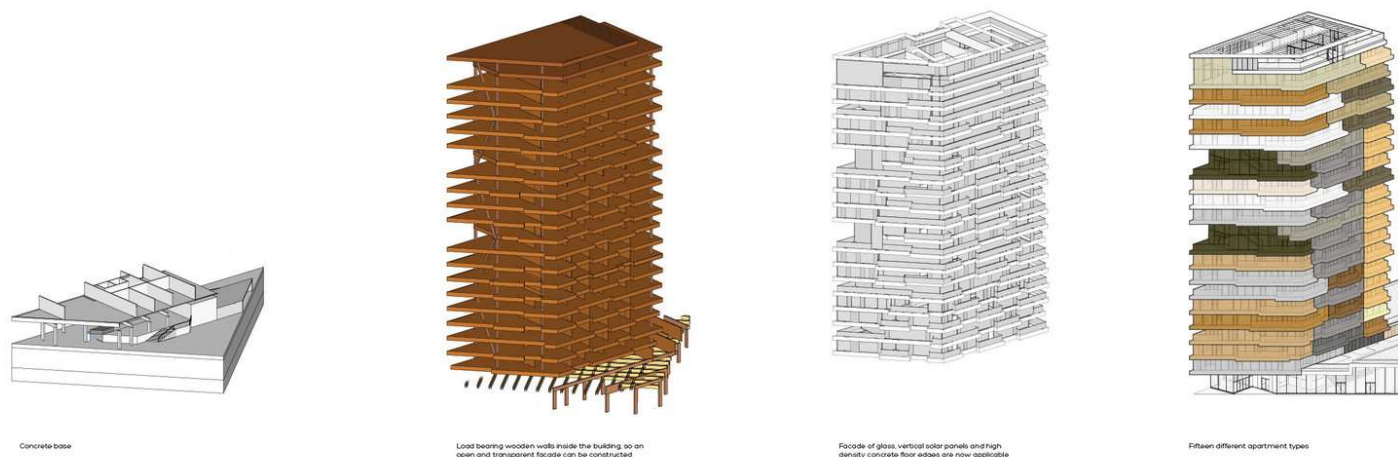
Diagramas del edificio HAUT. En orden, base del edificio, estructura de CLT, estructura de vidrio, y distribución de las diferentes viviendas.
